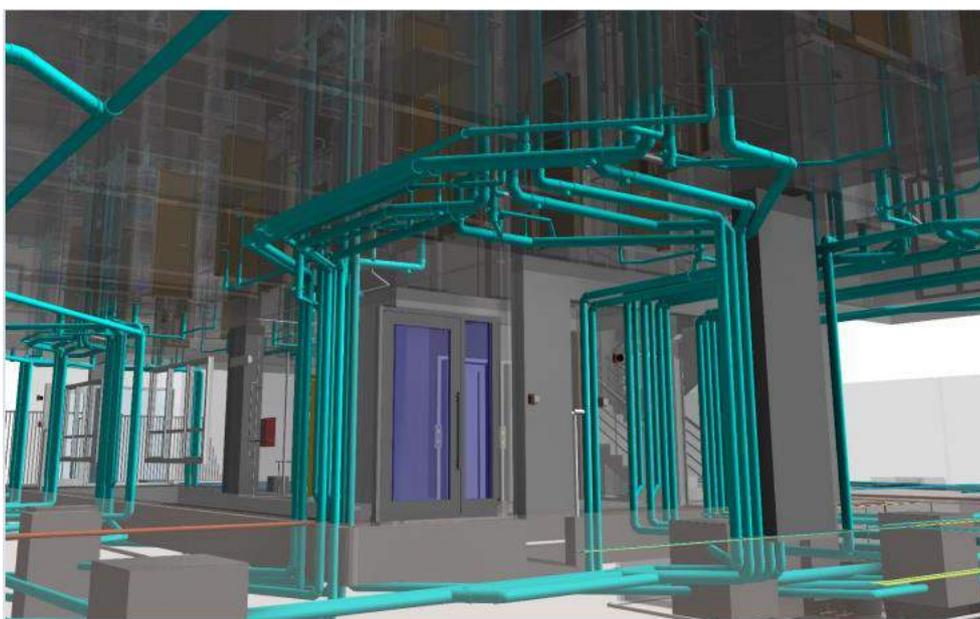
Ilustração da aplicação do BIM na construção civil.
